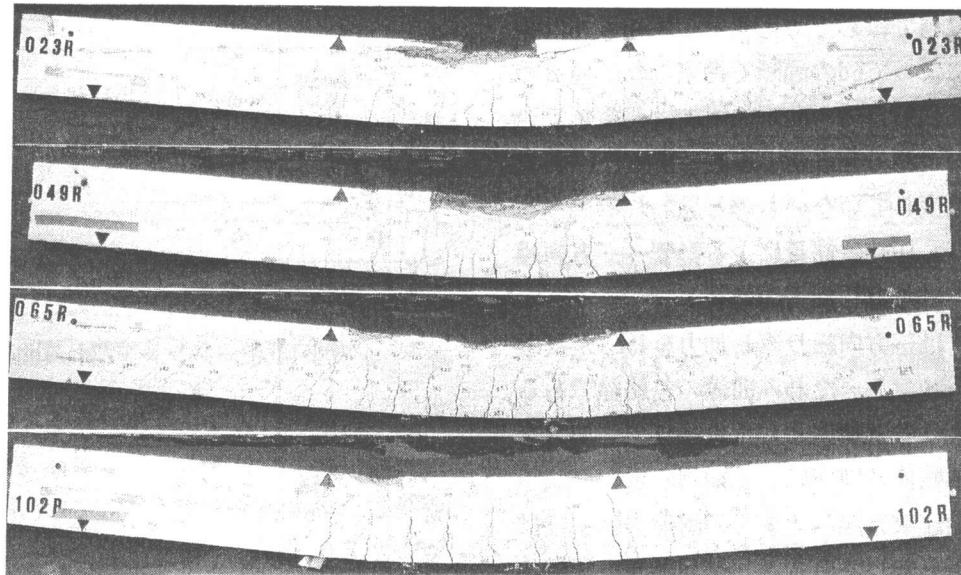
試験区間の最終破壊状況（正負繰り返し加力）
